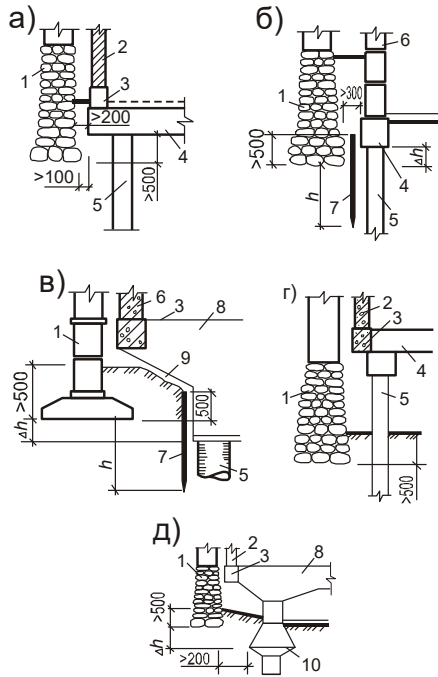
Примикання до існуючих фундаментів паливових фундаментів будинків:
